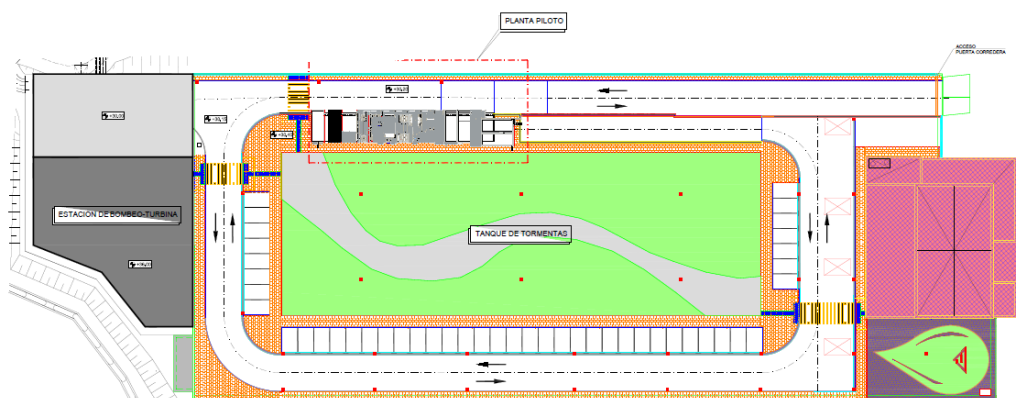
Vista en planta de la ubicación actual en el tanque de tormentas
